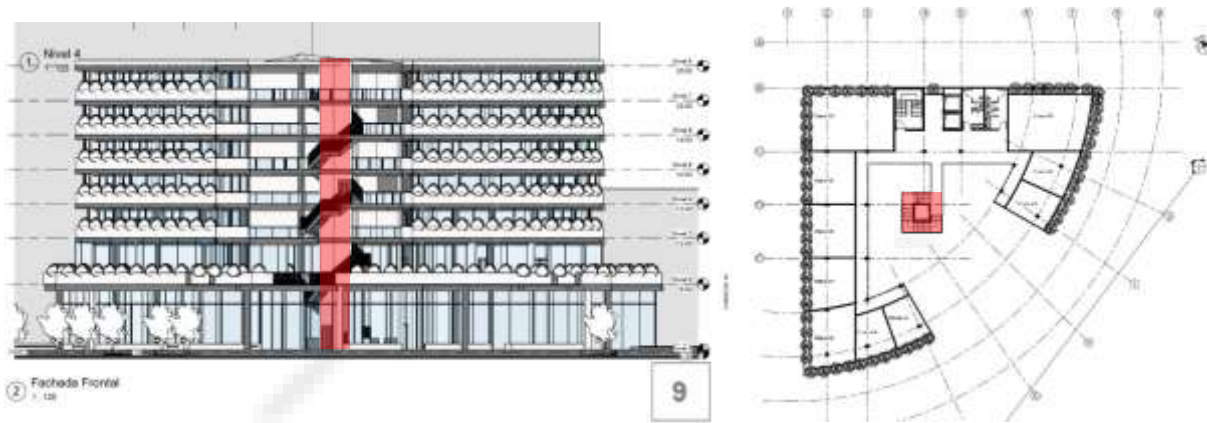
Proyecto Plan Kira Angie Katherin Franky
